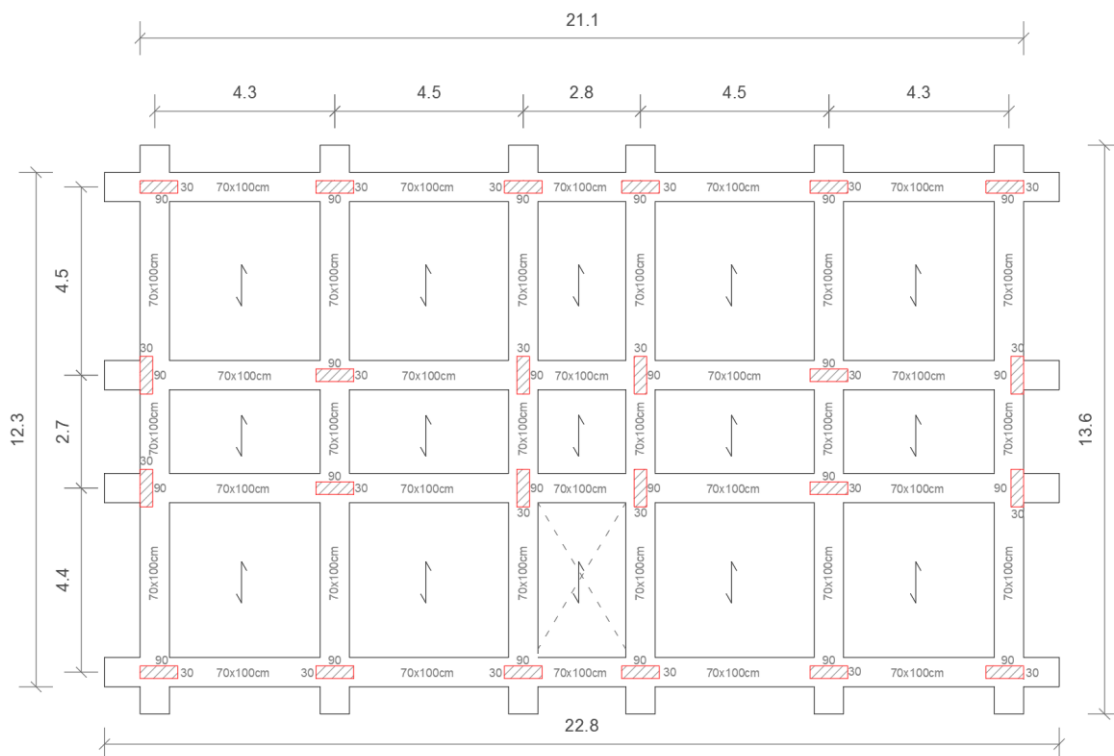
Carpenteria struttura in c.a. a tre piani con graticcio di travi rovesce.
